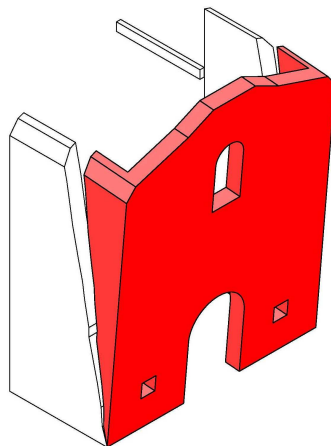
Interpretación del mecanismo. Desplome de fachada con grietas inclinadas.
